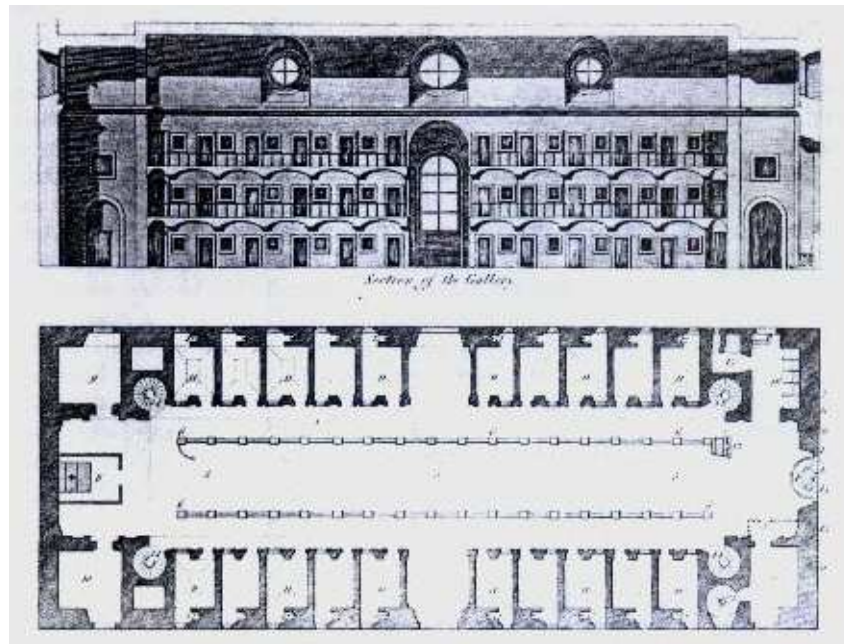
Elevação e Planta de *Prigione San Michelli*. (Fonte: PEVSNER, N. 1976)
